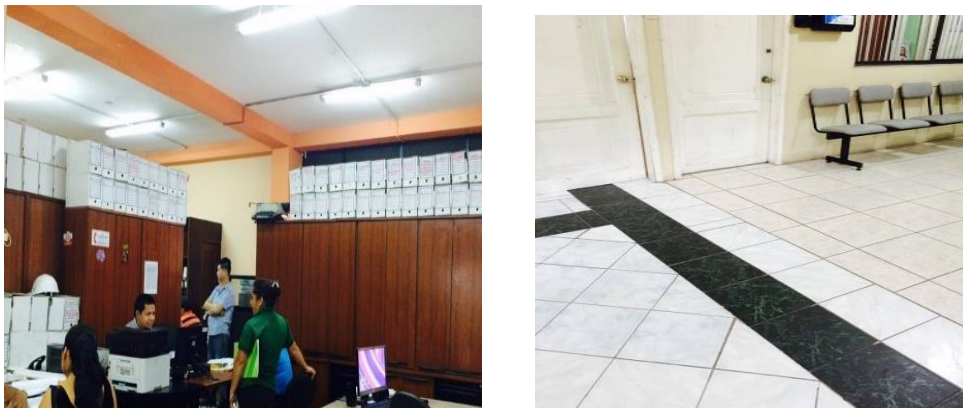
Instalaciones eléctricas y recubrimiento de pisos, planta baja
